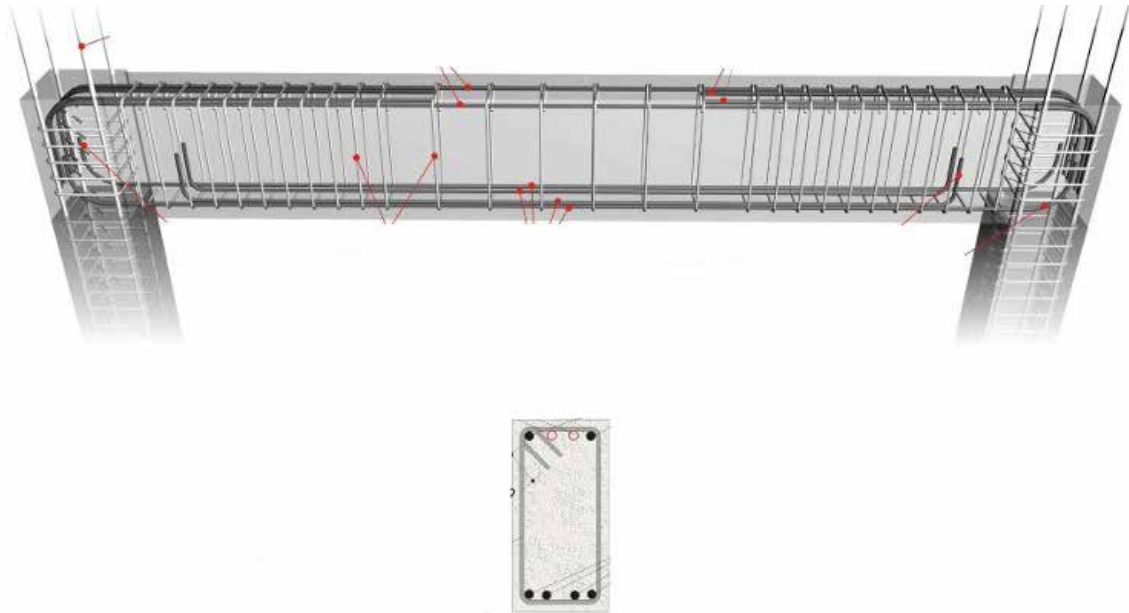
Viga de carga. Fuente: <http://civilgeeks.com/2014/01/17/manual-de-diseno-de-vigas-de-concreto-armado/> (2014)
